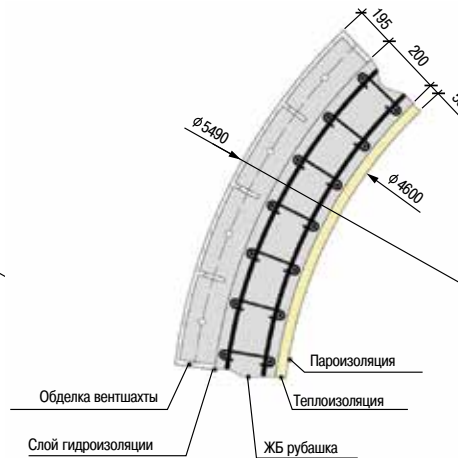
Конструкция железобетонной рубашки с несъемной теплоизоляционной опалубкой
